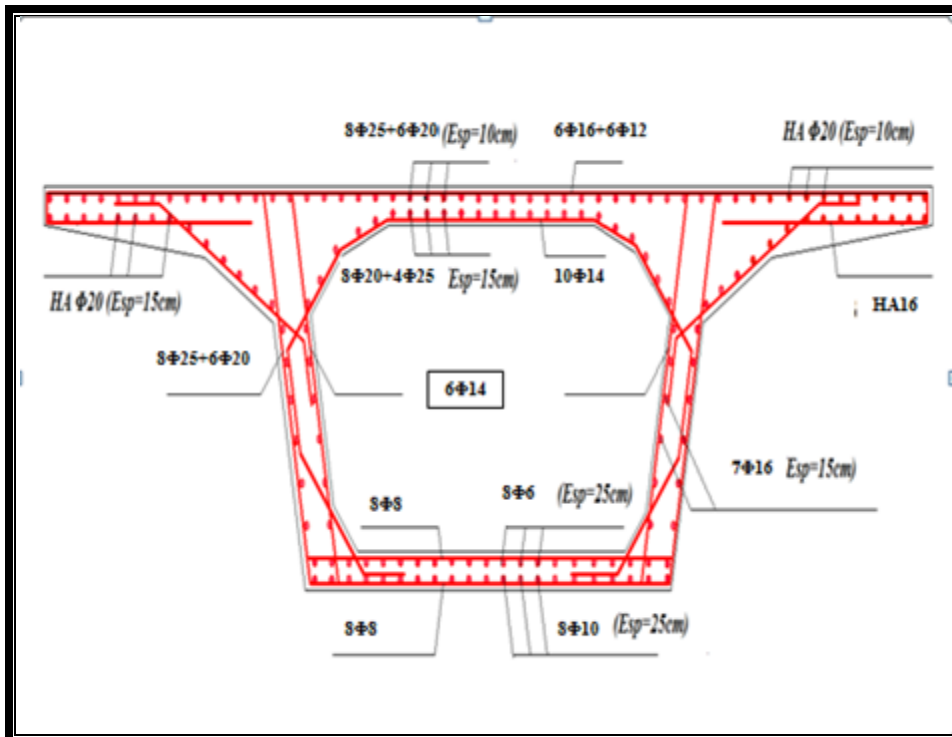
Schéma du Ferrailage du voussoir près de la clé.
